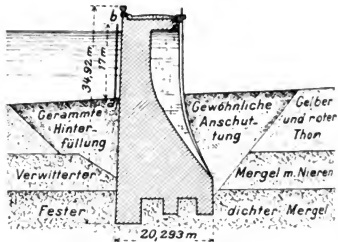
bis 93. Abdichtungsbekleidung der Mouche-Talsperre aus Eisenbeton.
